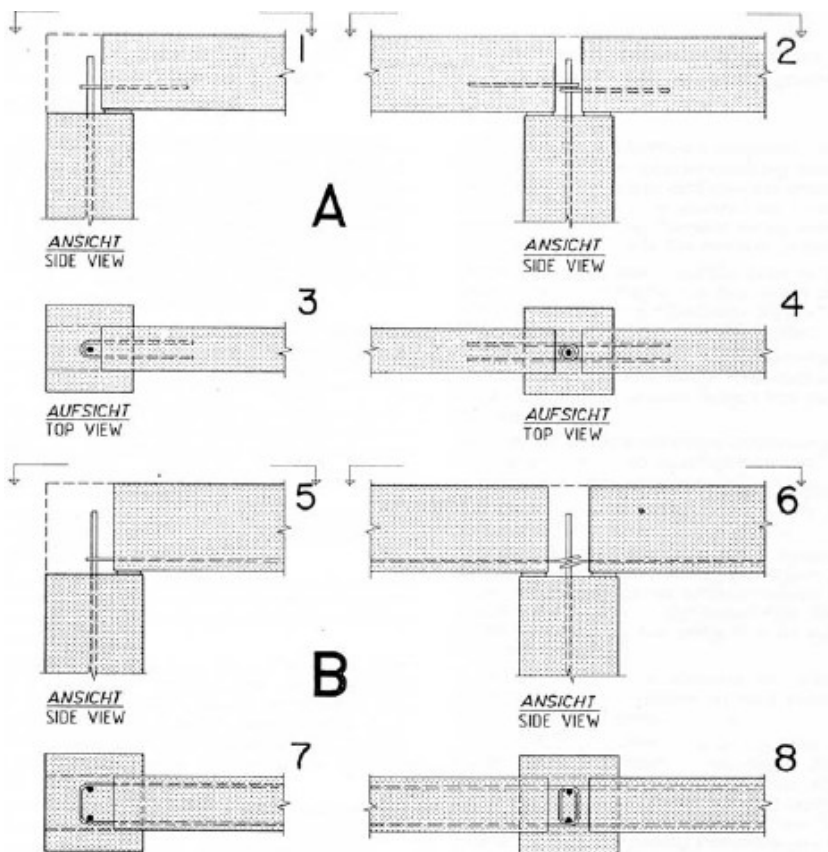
Ligação com armadura em gancho (Stupré, 1981)
